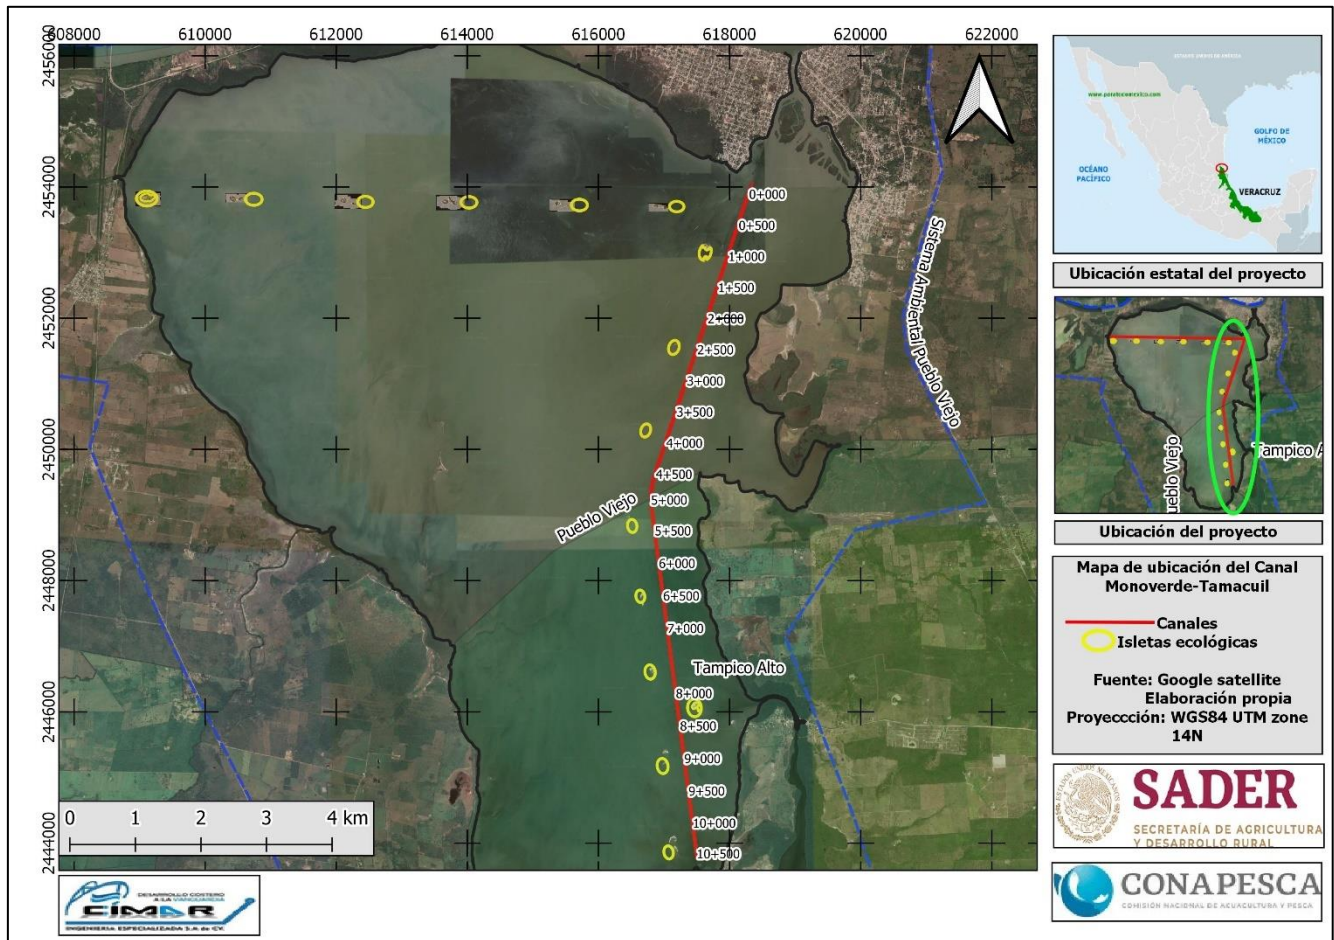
Disposición en planta del Canal Mono Verde-Tamacuil.
